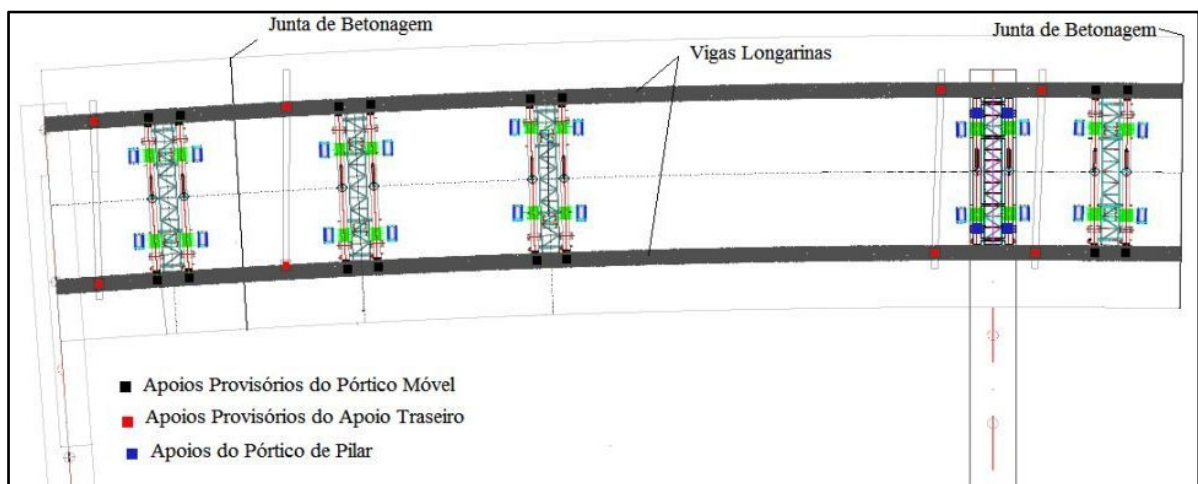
Esquema dos apoios para o pórtico móvel, pórtico de pilar e apoio traseiro ao longo de um tramo
